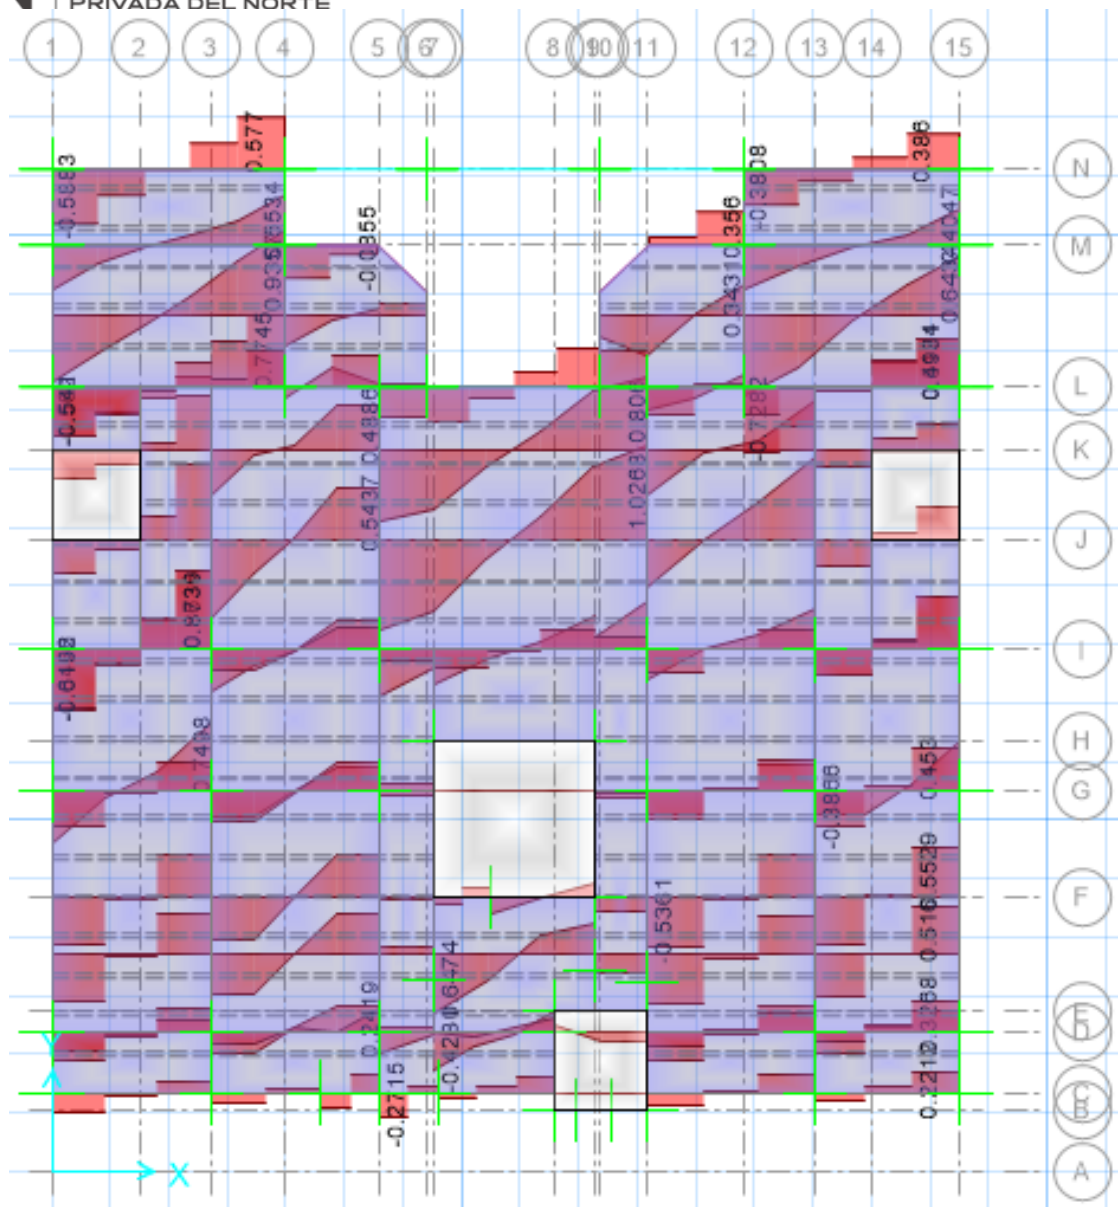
Diagrama de la fuerza de corte del piso más crítico de la losa Vigacero en dirección "X".
